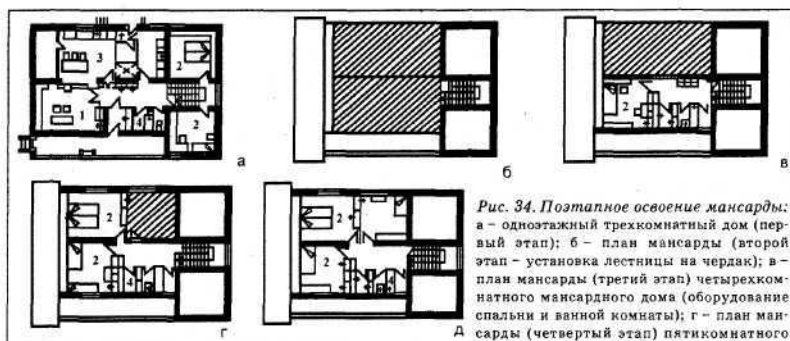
Поэтапное освоение мансарды: а – одноэтажный трехкомнатный дом (первый этап); б – план мансарды (второй этап – установка лестницы на чердак); в – план мансарды (третий этап) четырехкомнатного мансардного дома (оборудование спальни и ванной комнаты); г – план мансарды (четвертый этап) пятикомнатного мансардного дома (оборудование спальни); д – план мансарды (пятый этап) шестикомнатного мансардного дома (оборудование спальни и туалета)
